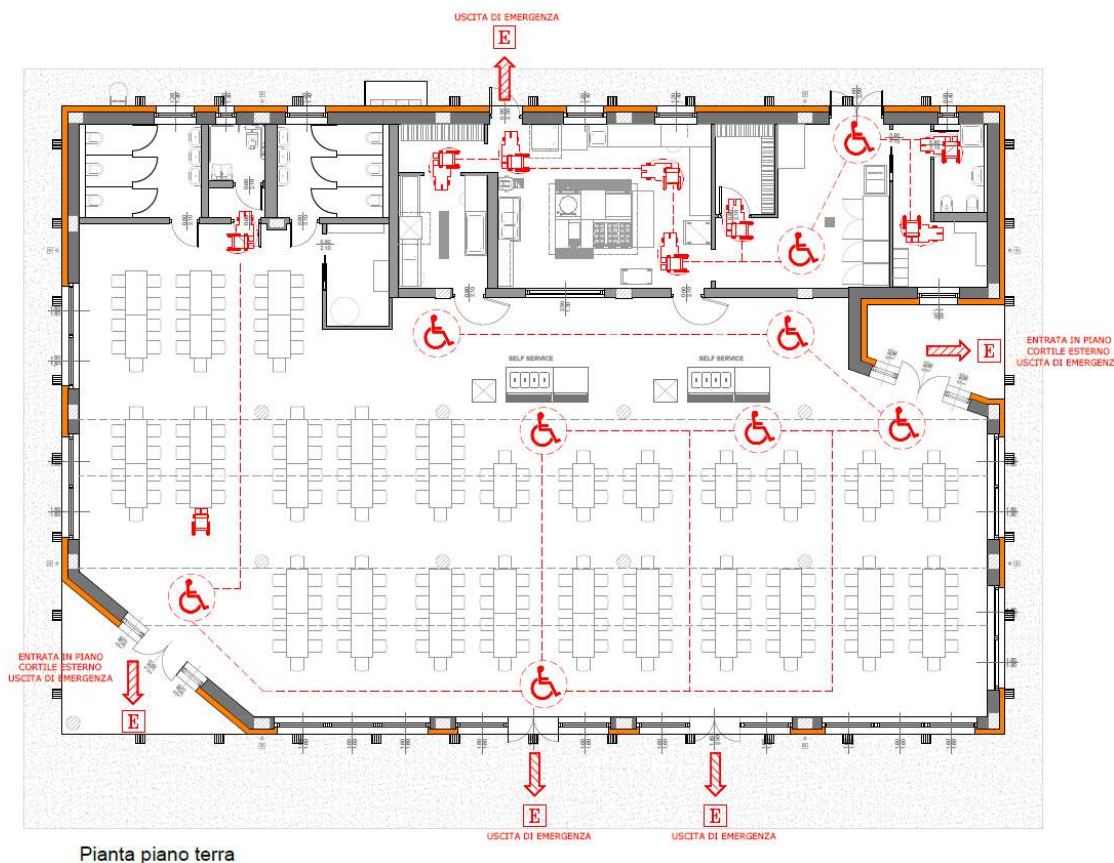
Pianta piano terra con verifica accessibilità. Estratto Tav.07_Abbattimento barriere architettoniche
